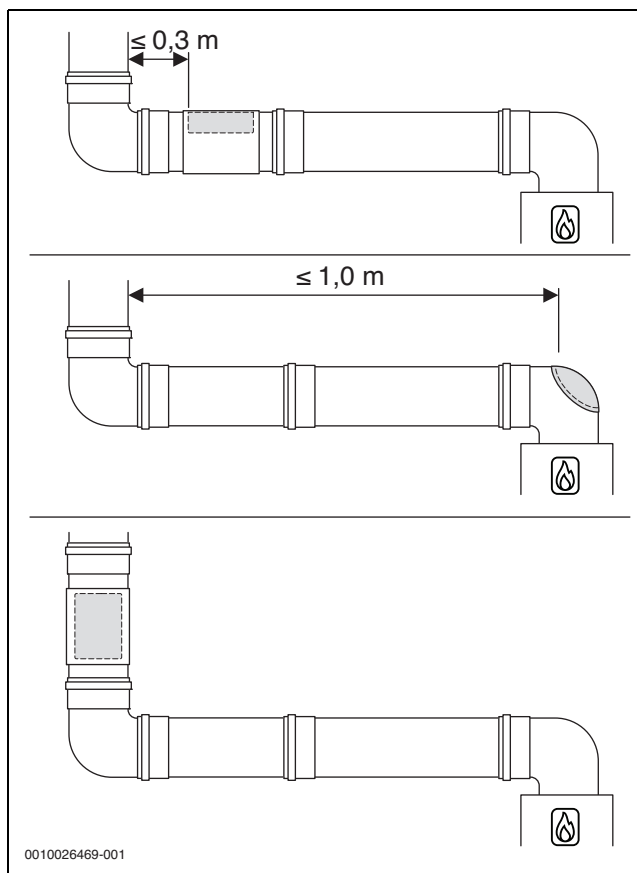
disposizione dell'apertura d'ispezione inferiore
